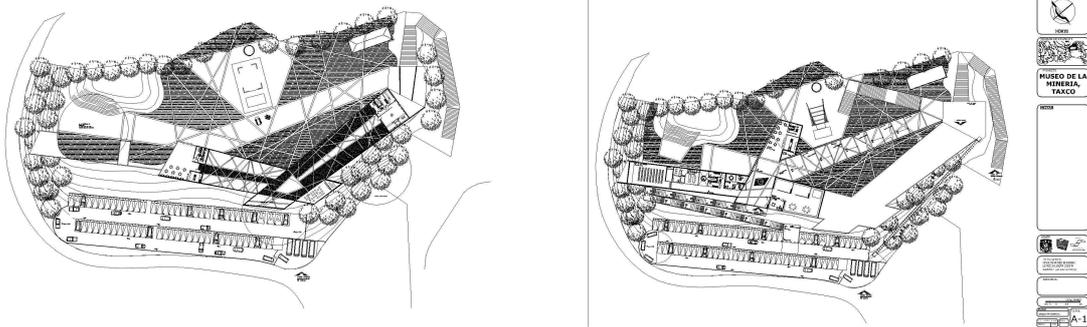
Planta Arquitectónica Final Zona Exposiciones IMAGEN 61. Planta Arquitectónica Final Zona Servicios
